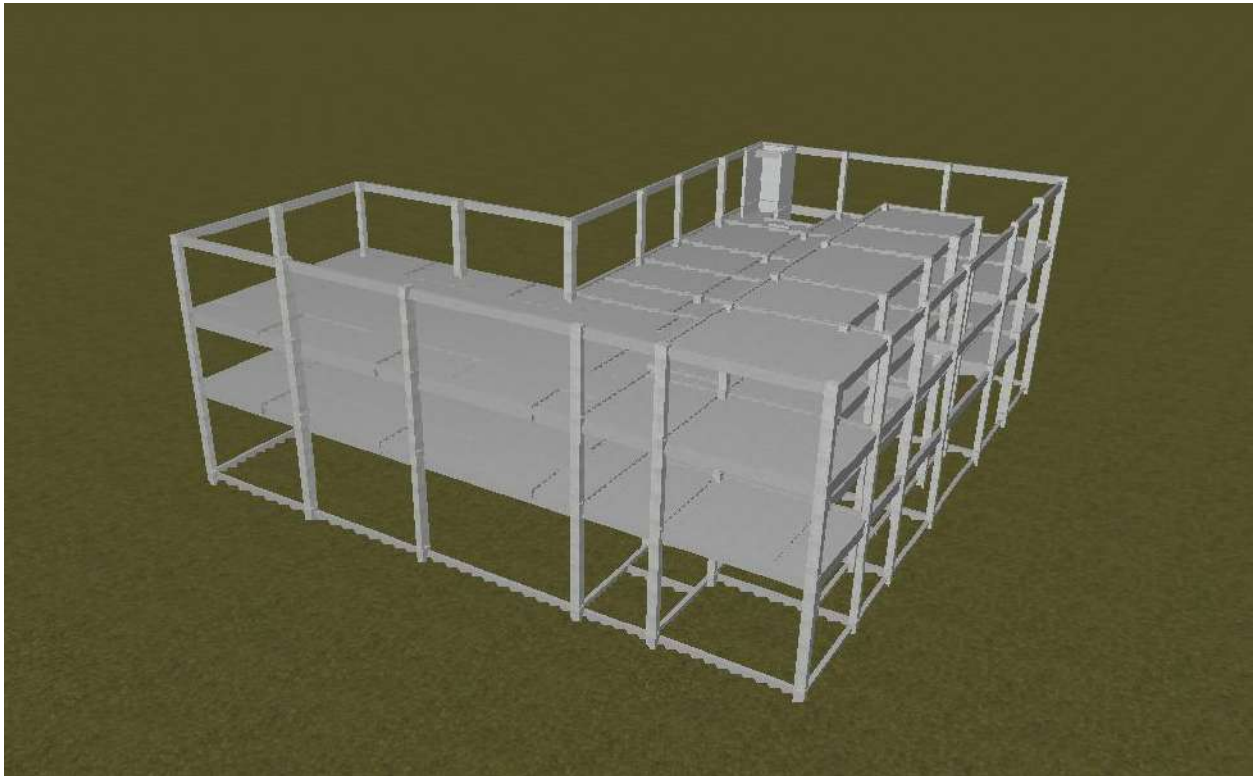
Modelado de la estructura de Hormigón Fuente: Imagen de Cypecad
